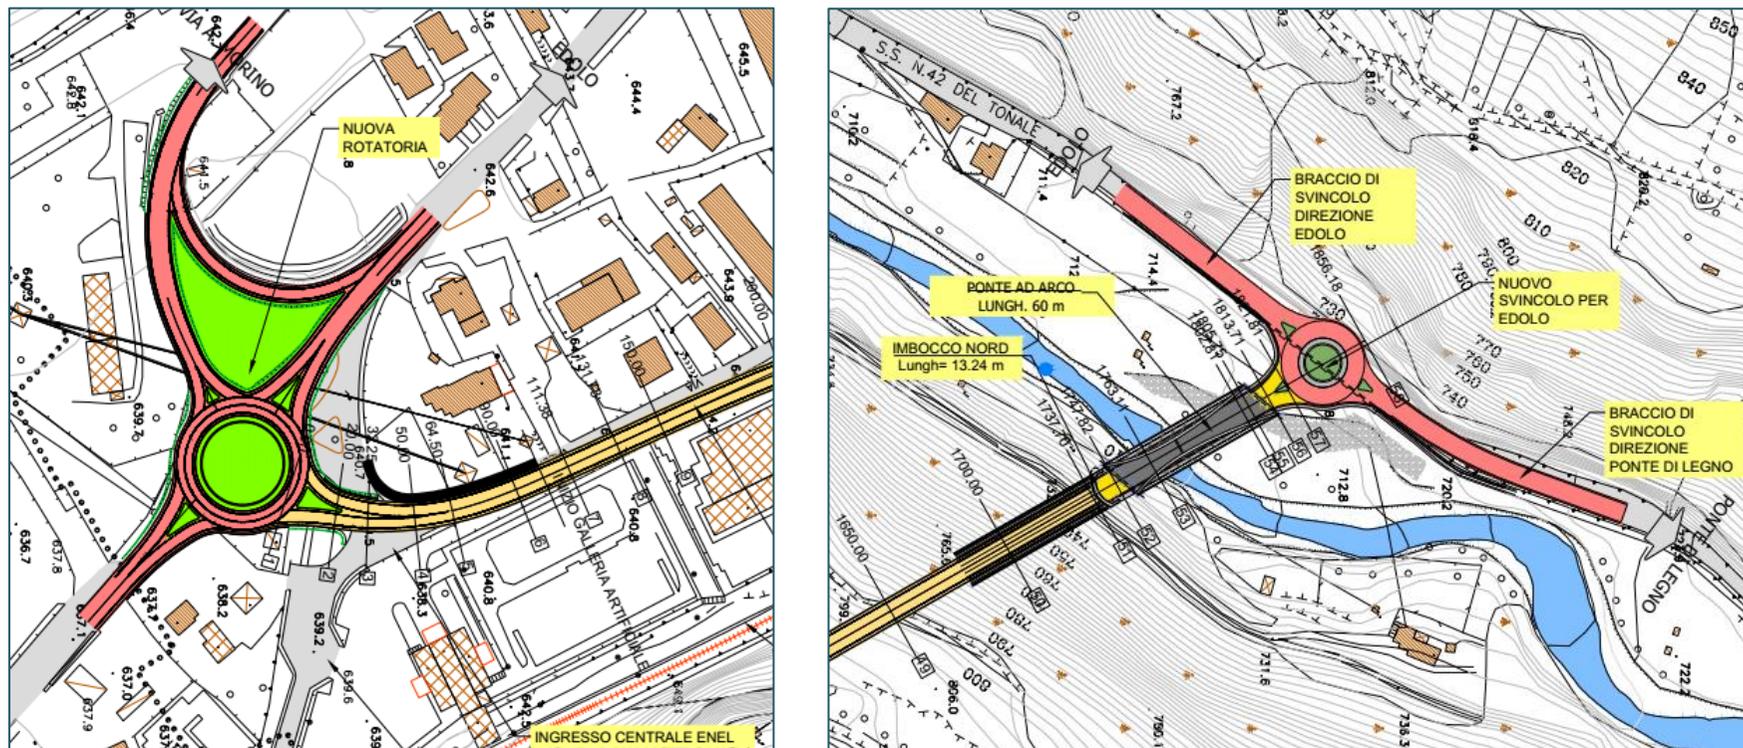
Schema planimetrico delle rotatorie da Progetto Preliminare
